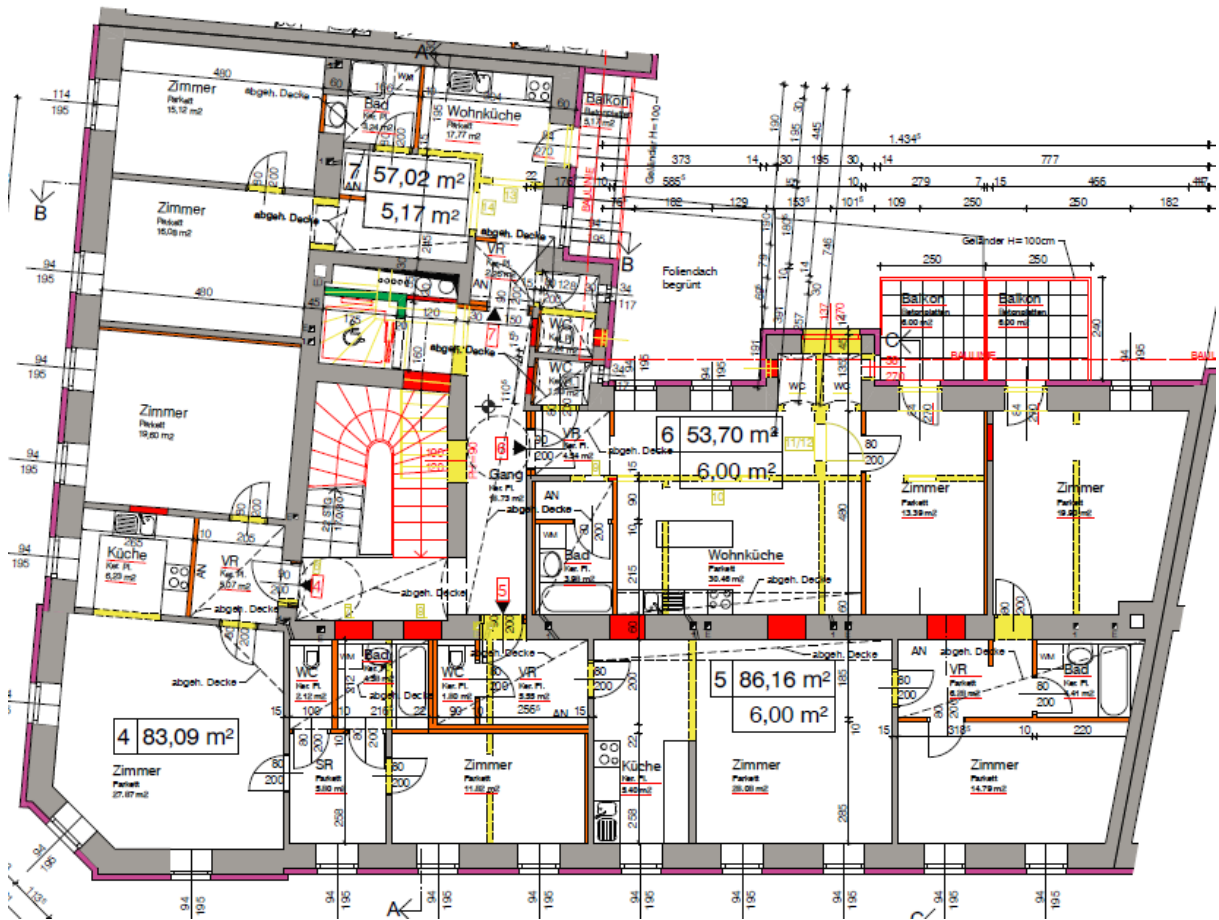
Ecke David-Muhrengasse, Grundriss 1. Stock (Quelle: Auswechslungsplan 06.07.2010)
